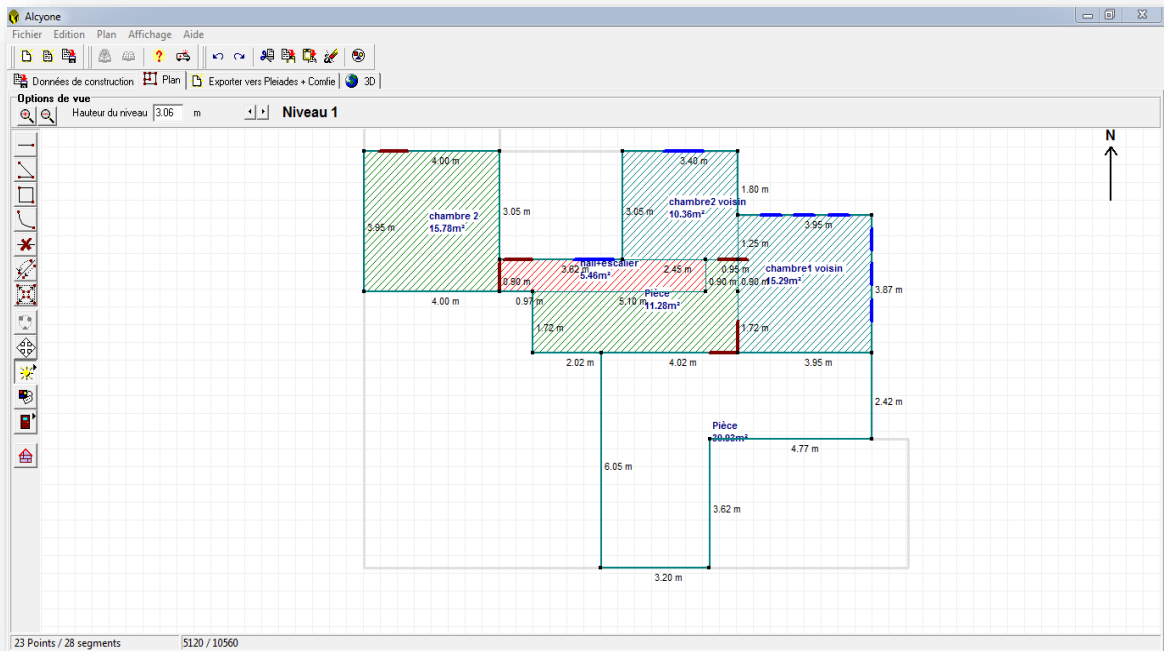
PLAN DE 1 ETAGE DESSINE PAR ALCYONE
